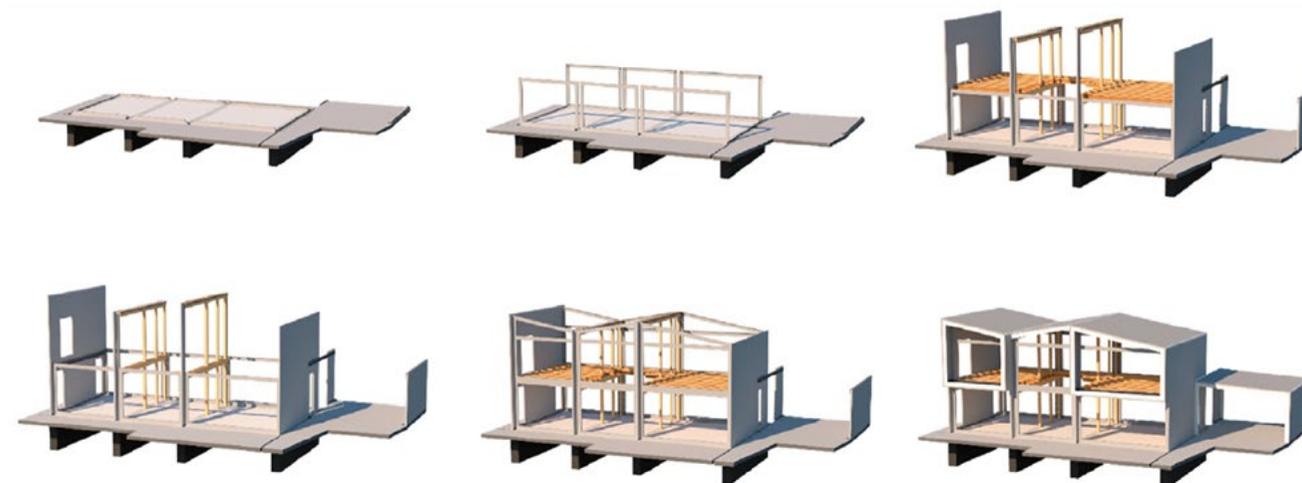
Esquema de montaje 3D vivienda Pontevedra ACG.
